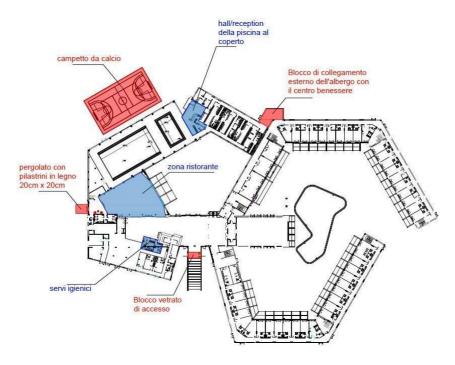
Estratto dell'Allegato 5: Piano terra come da rilievo
